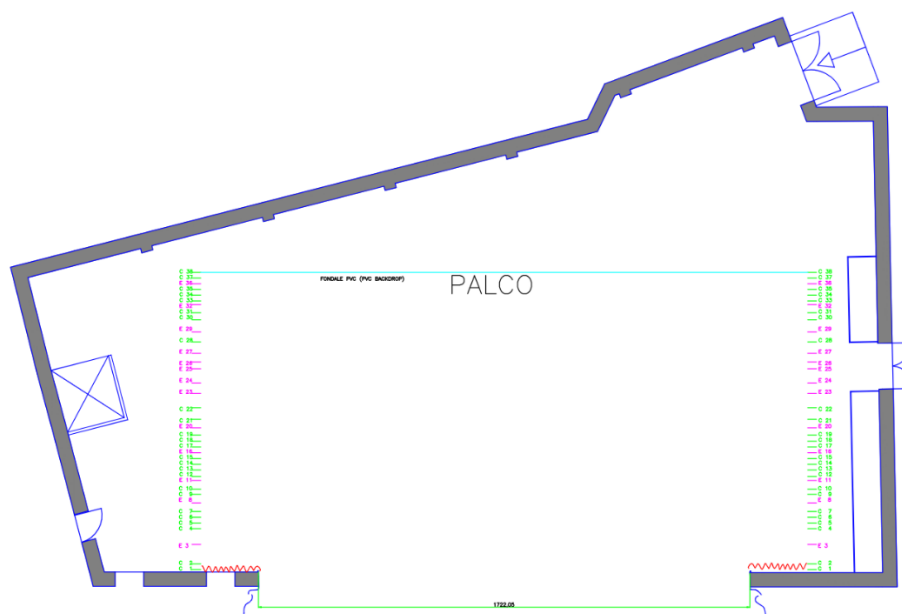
Coliseu do Porto: planta de palco, adaptado de [60]
